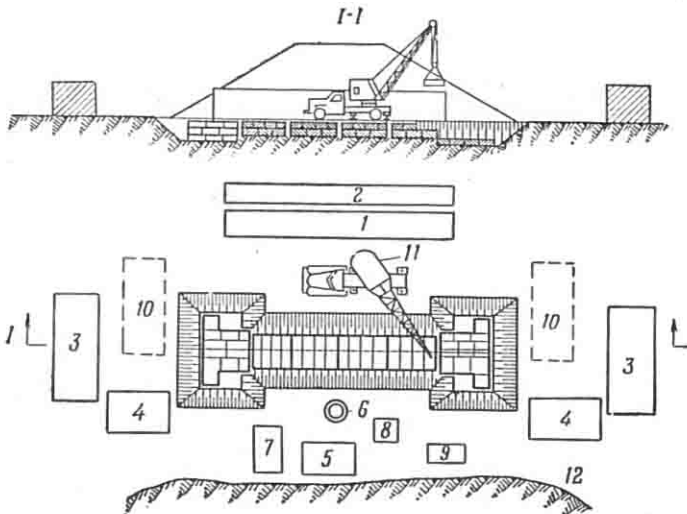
Схема строительной площадки по сооружению сборной железобетонной трубы;
